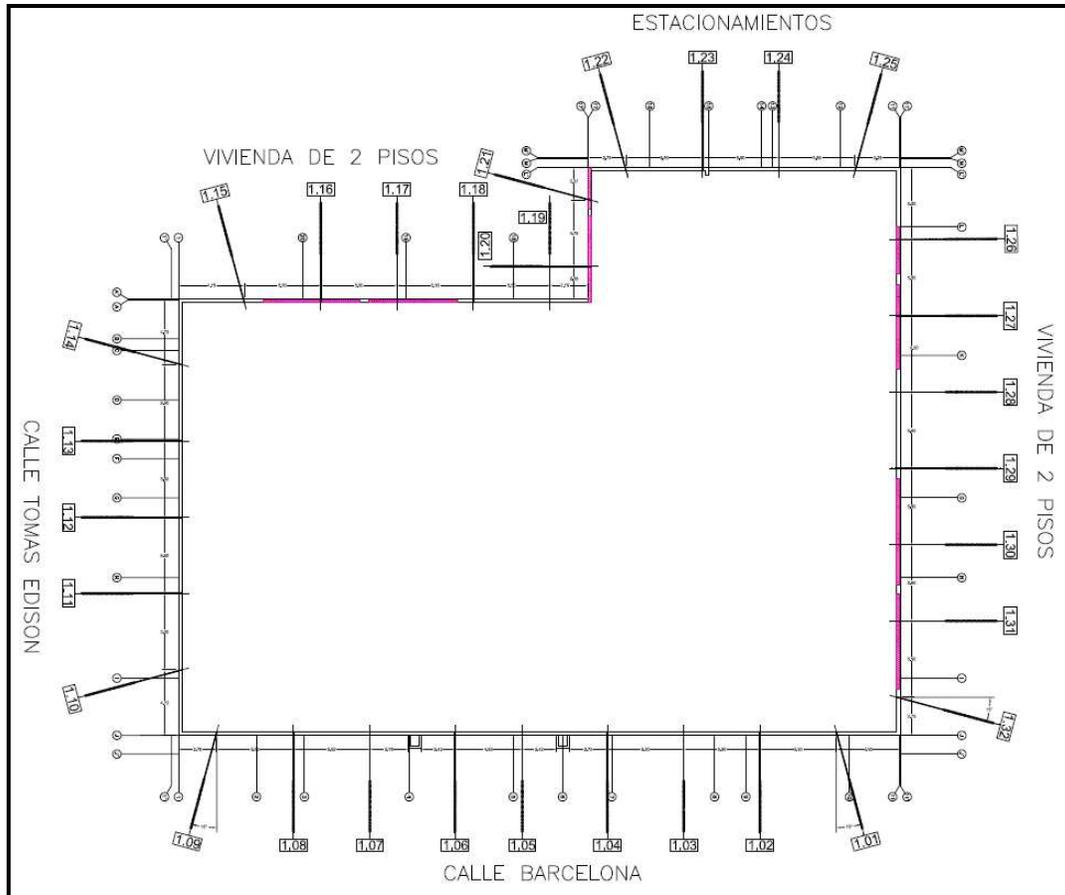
Plano en planta obra 1: Edificio Barcelona - Muro anclado.
